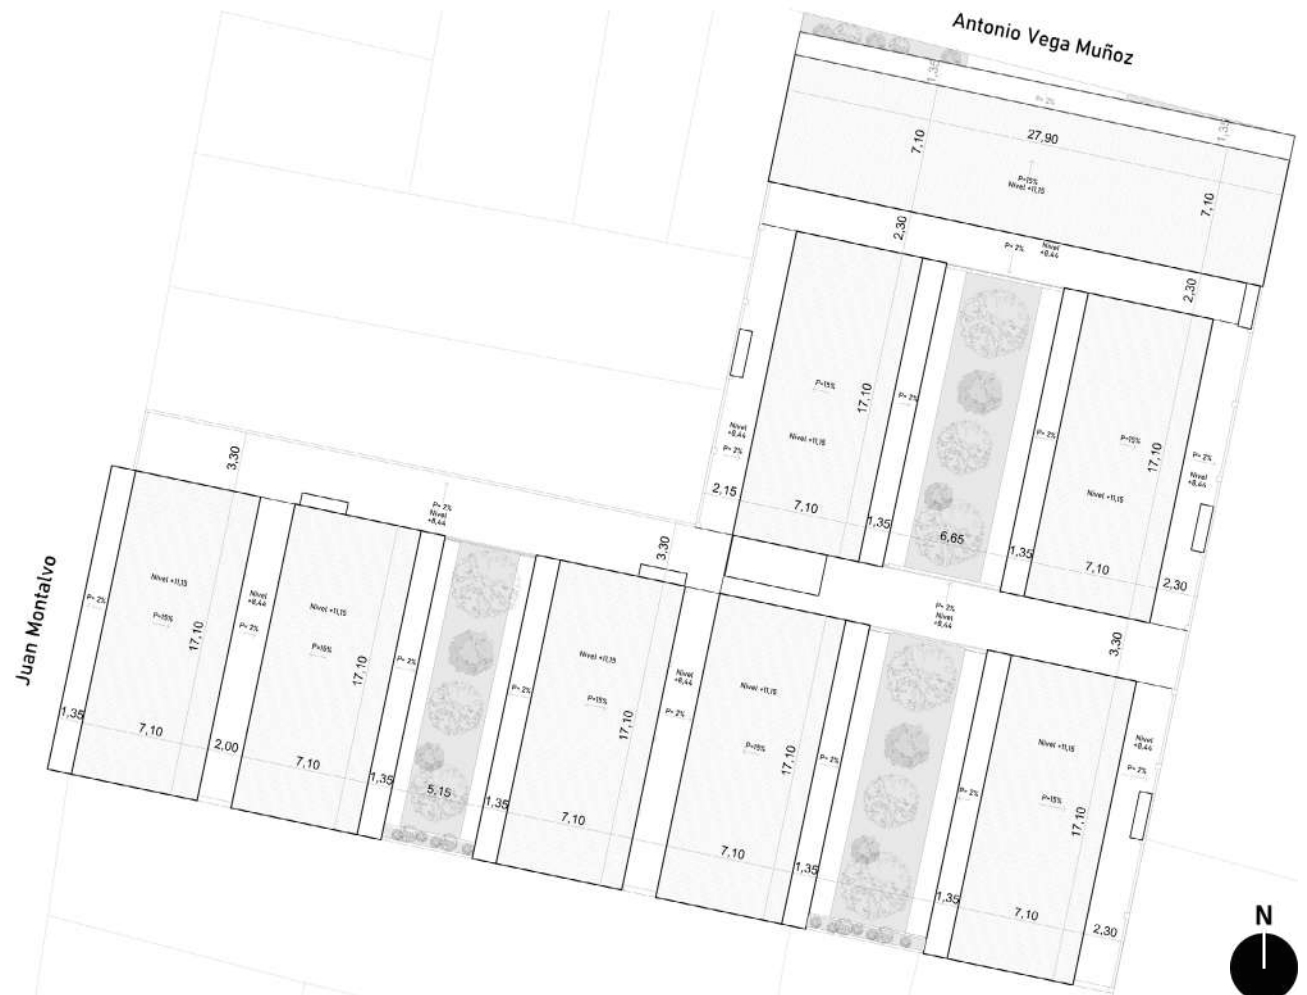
Planta de cubiertas Fuente: Elaboración Propia
